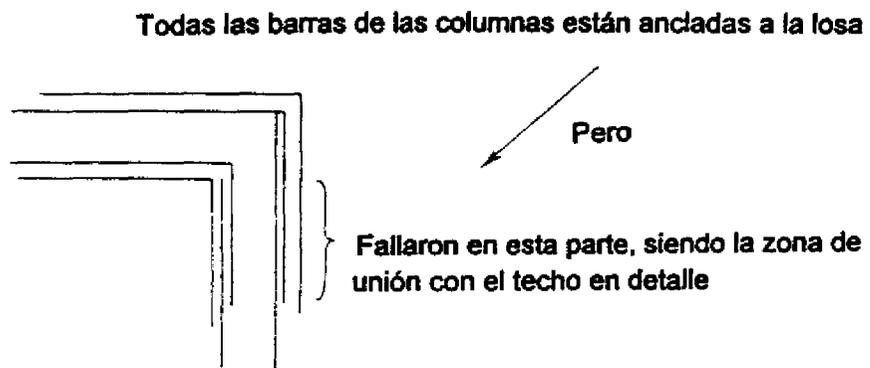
Detalle del anclaje del refuerzo longitudinal de las columnas en el sistema de piso del edificio del cuerpo central (detalle 1, de la Figura 14)
